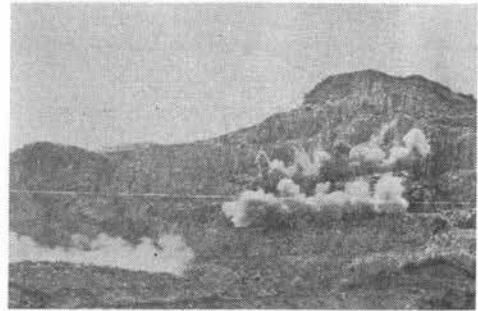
地山爆砕と 45 m 盤の小割発破の状況
